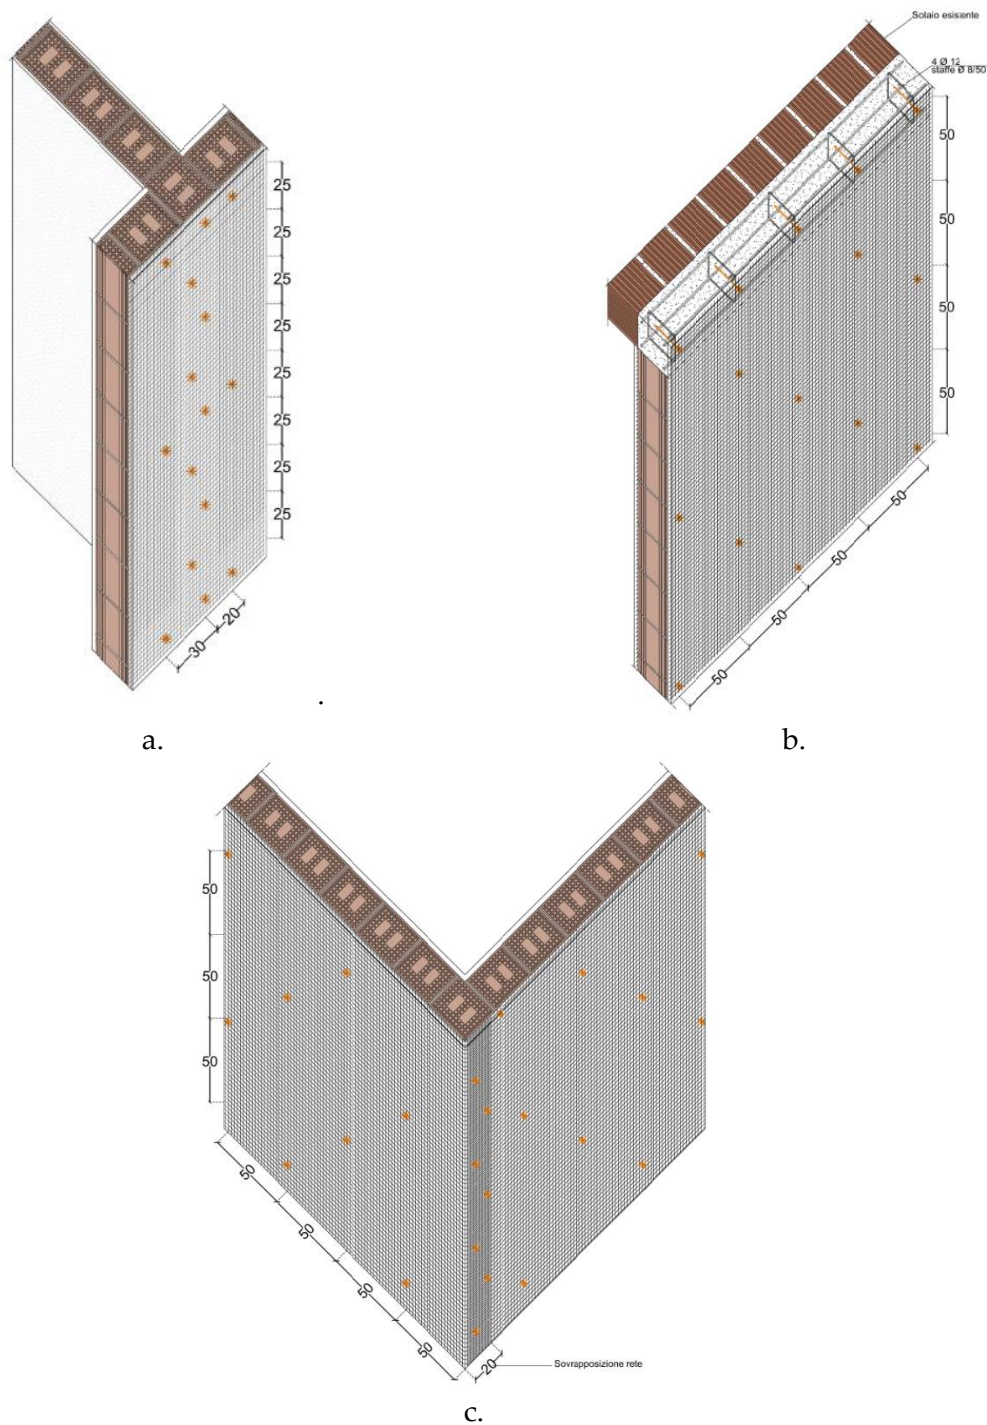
Schema assometrico connessione: a) martelli murari; b) ultimo solaio; c) cantonali.
